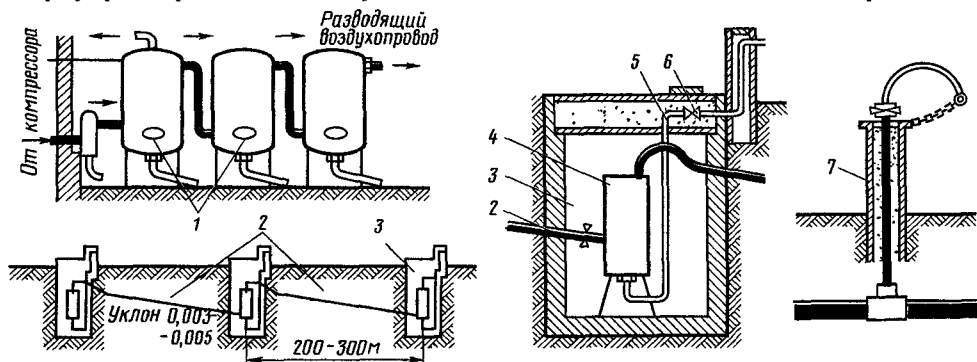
Главные резервуары и разводящий воздухопровод со смотровыми колодцами и воздухоотборными колонками
